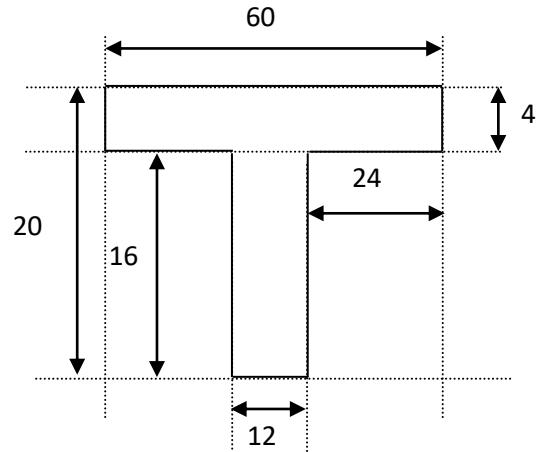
Schéma de poutrelle (Section de calcul)
